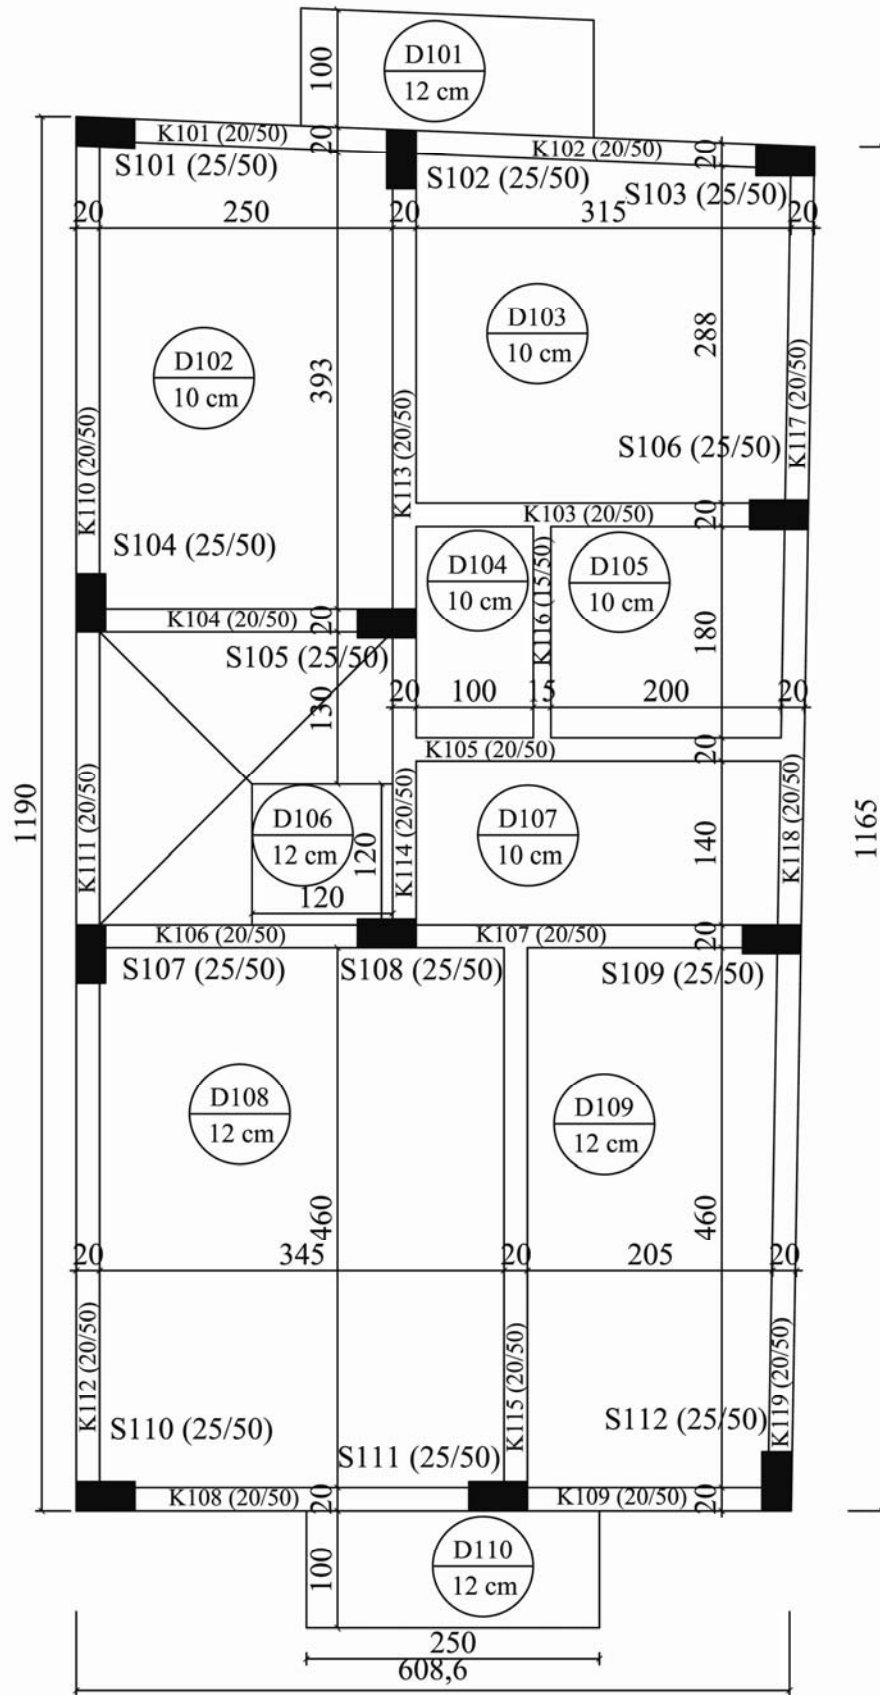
B4\_3'ün kat kalıp planı
